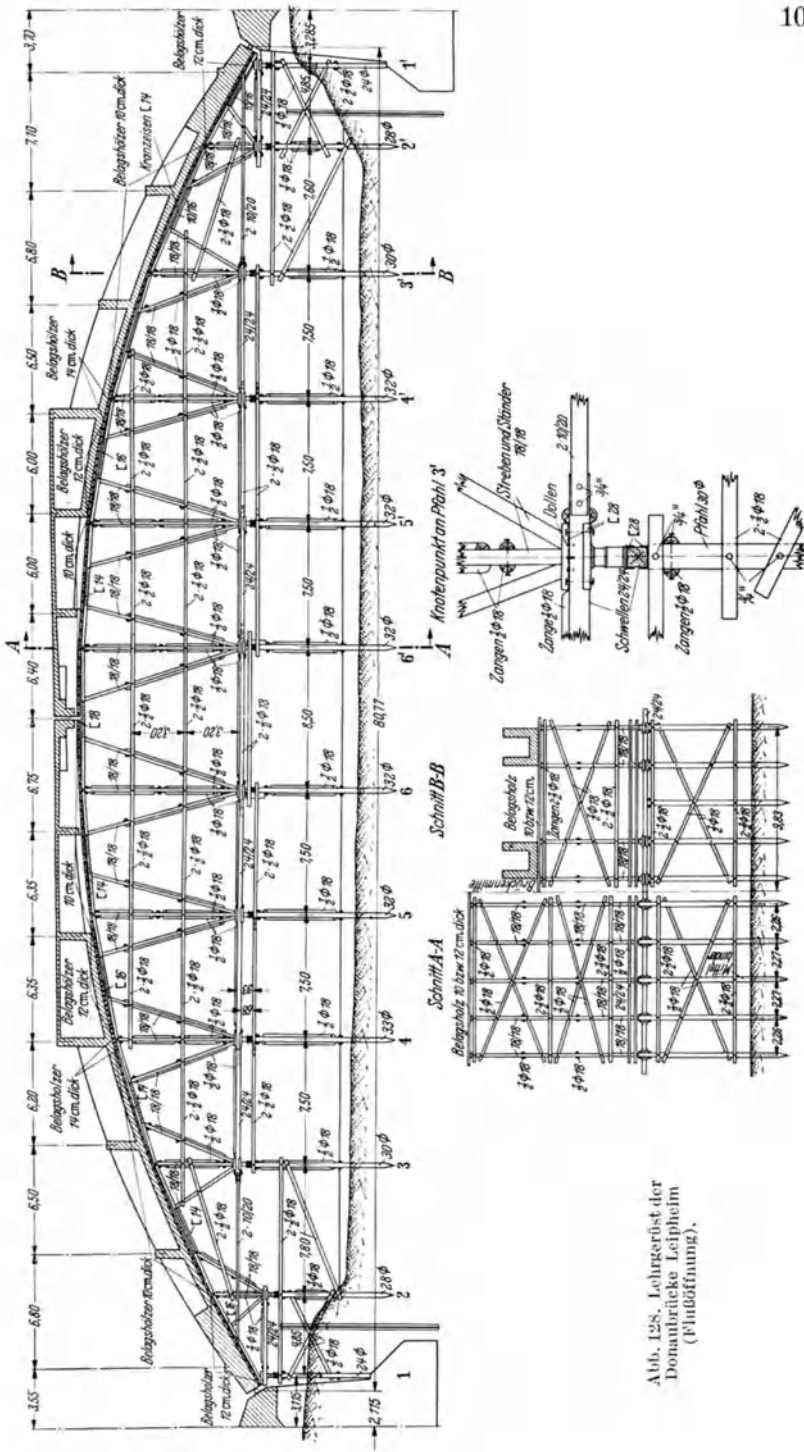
Lehrgerüst der Dombrücke Leiphelm (Flußöffnung).
